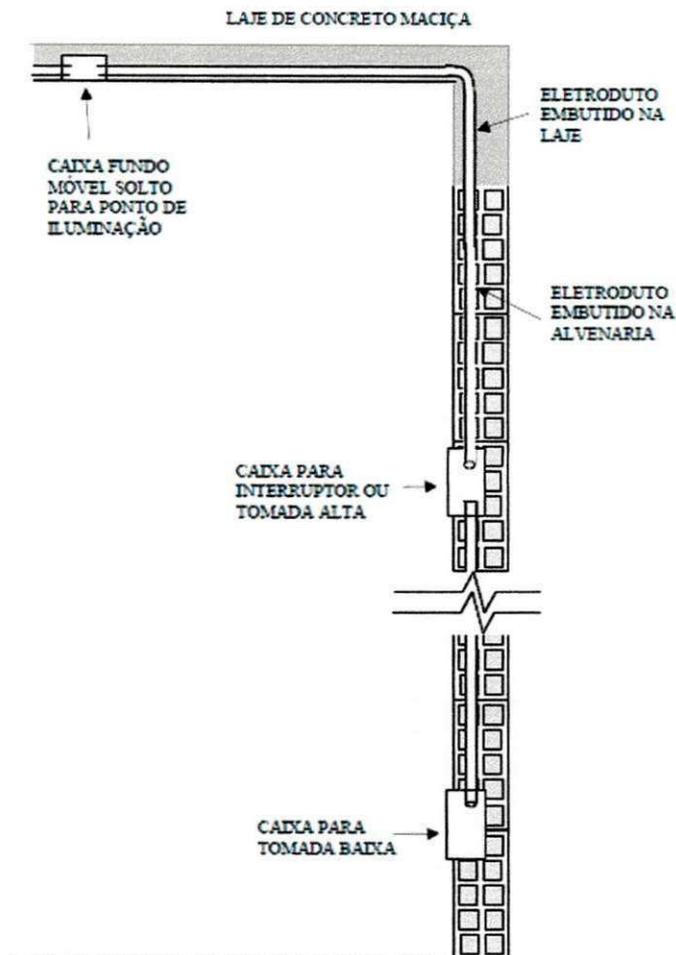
Detalhe das instalações elétricas em laje de concreto e parede.
